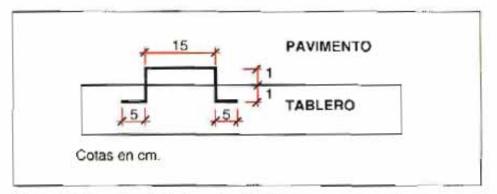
Viaducto de Valladares. Detalle de los conectores situados entre tublero y pavimento.
